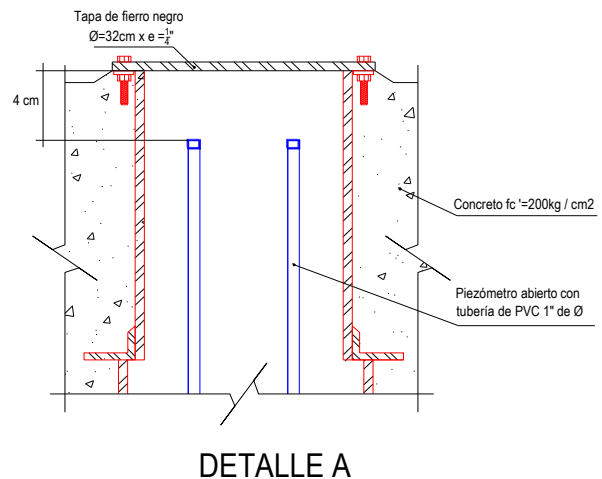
Diseño de piezómetro abierto complementario de proyecto ejecutivo y detalles de construcción (Fuente CONAGUA-COMISSA, 2010).
